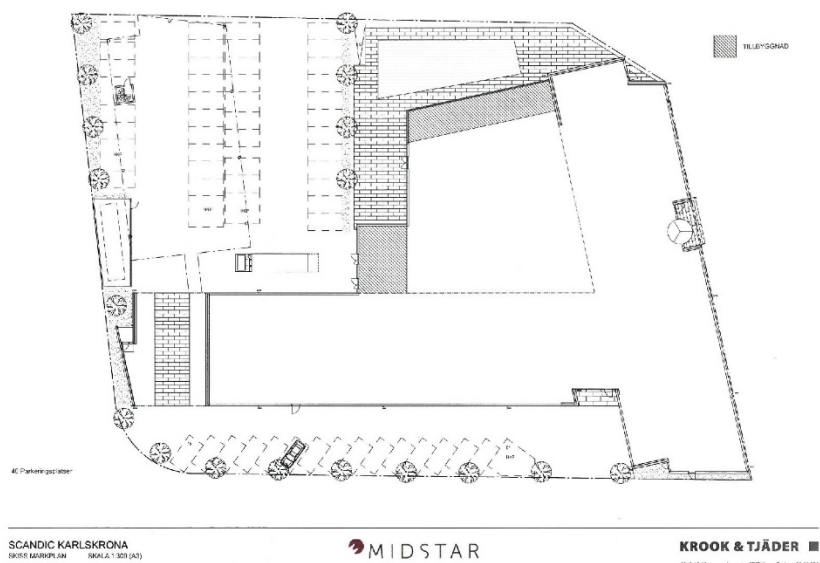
Illustrationsplan som visar möjlig tillbyggnad efter planändring.
